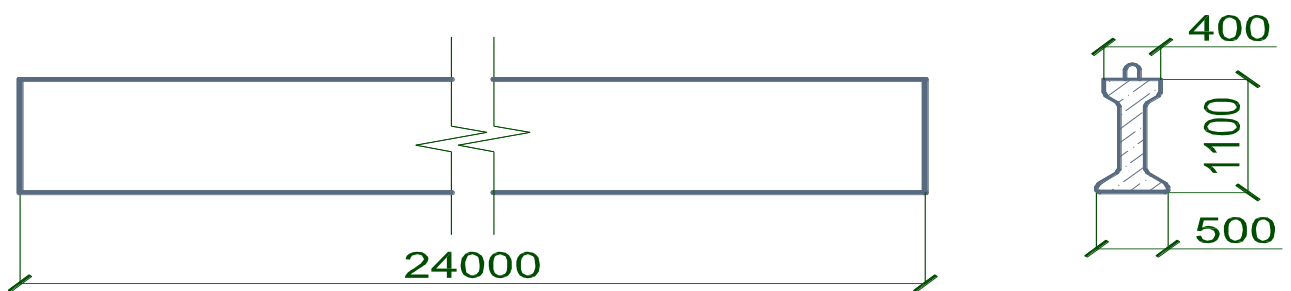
Попередньо напружена залізобетонна балка 24 м
